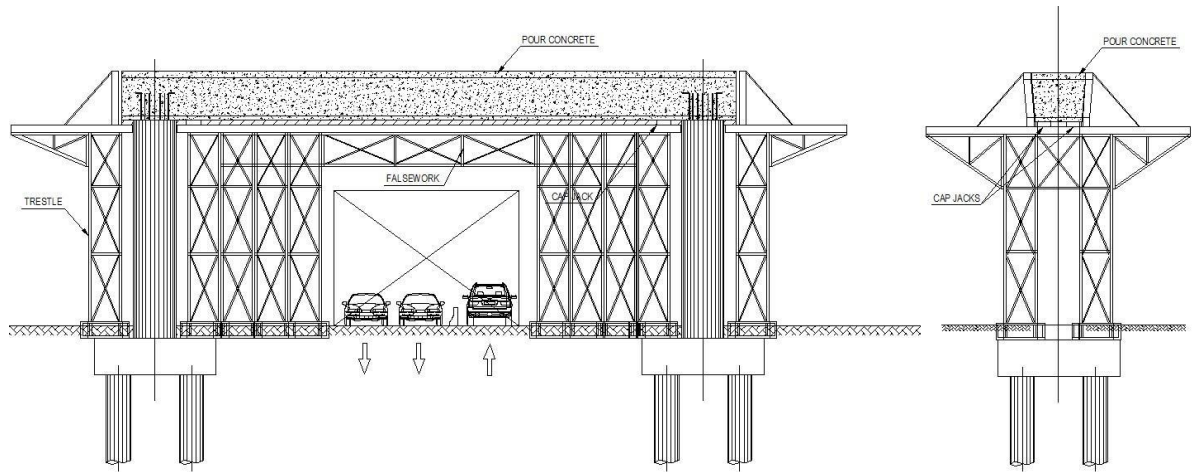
Croquis mostrando procedimiento de ejecución de pórtico $L < 15$ m
